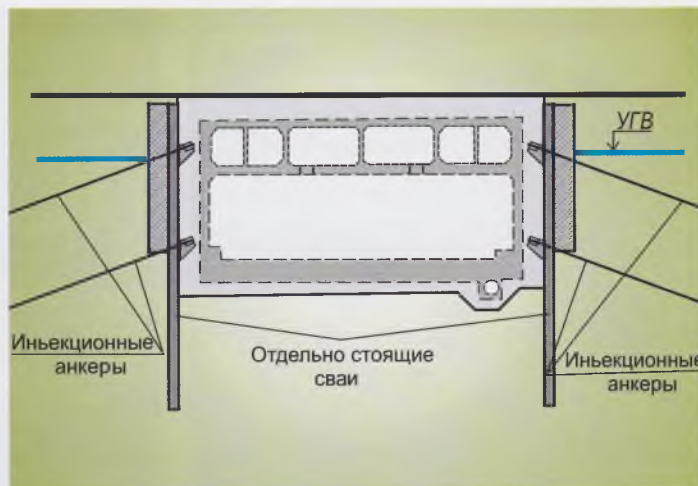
Анкерное крепление котлована (ширина котлована более 30-32 м)
